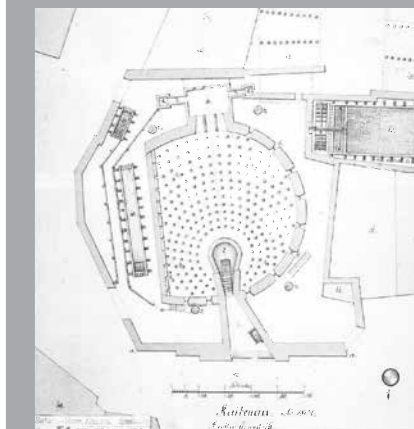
Grundriss des Sudhauses Raitenau. Gezeichnet 1802.
